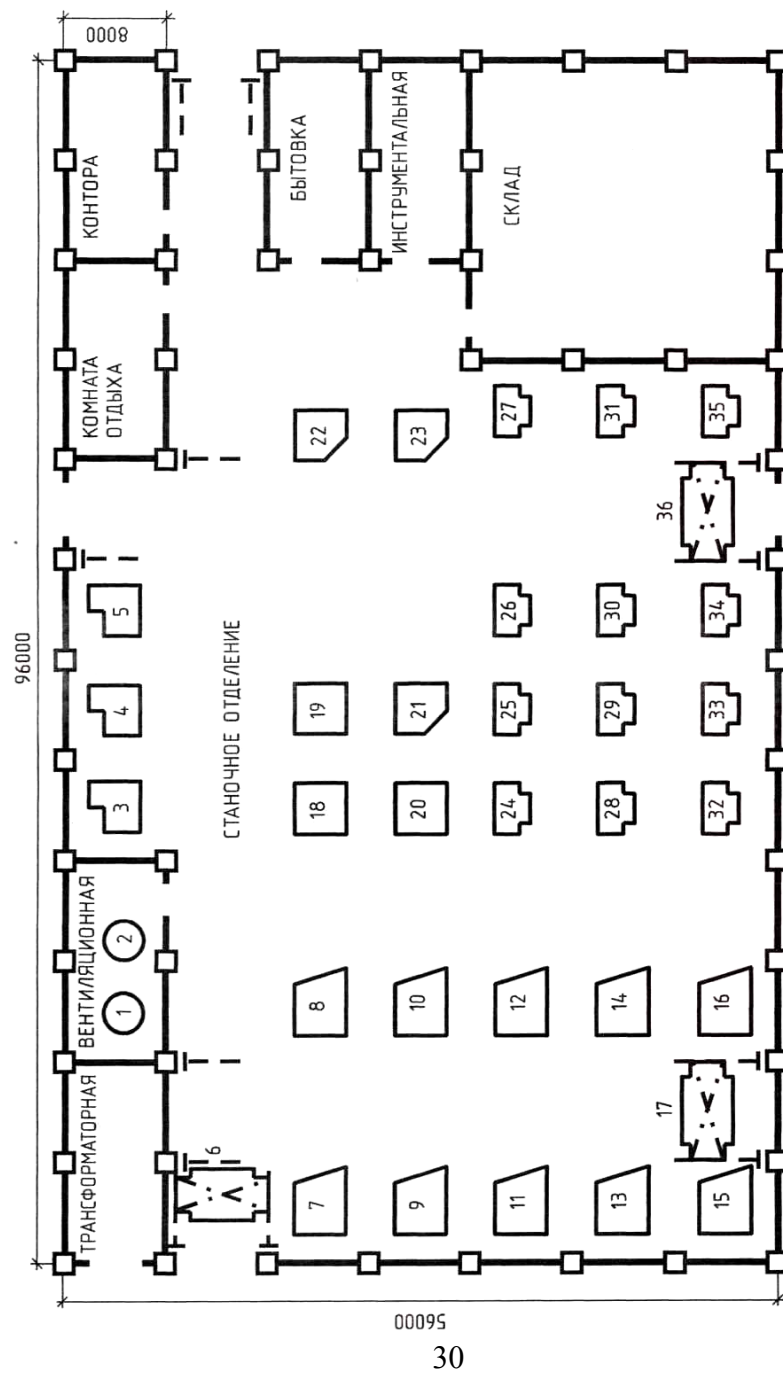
План расположения ЭО участка кузнечно-прессового цеха
